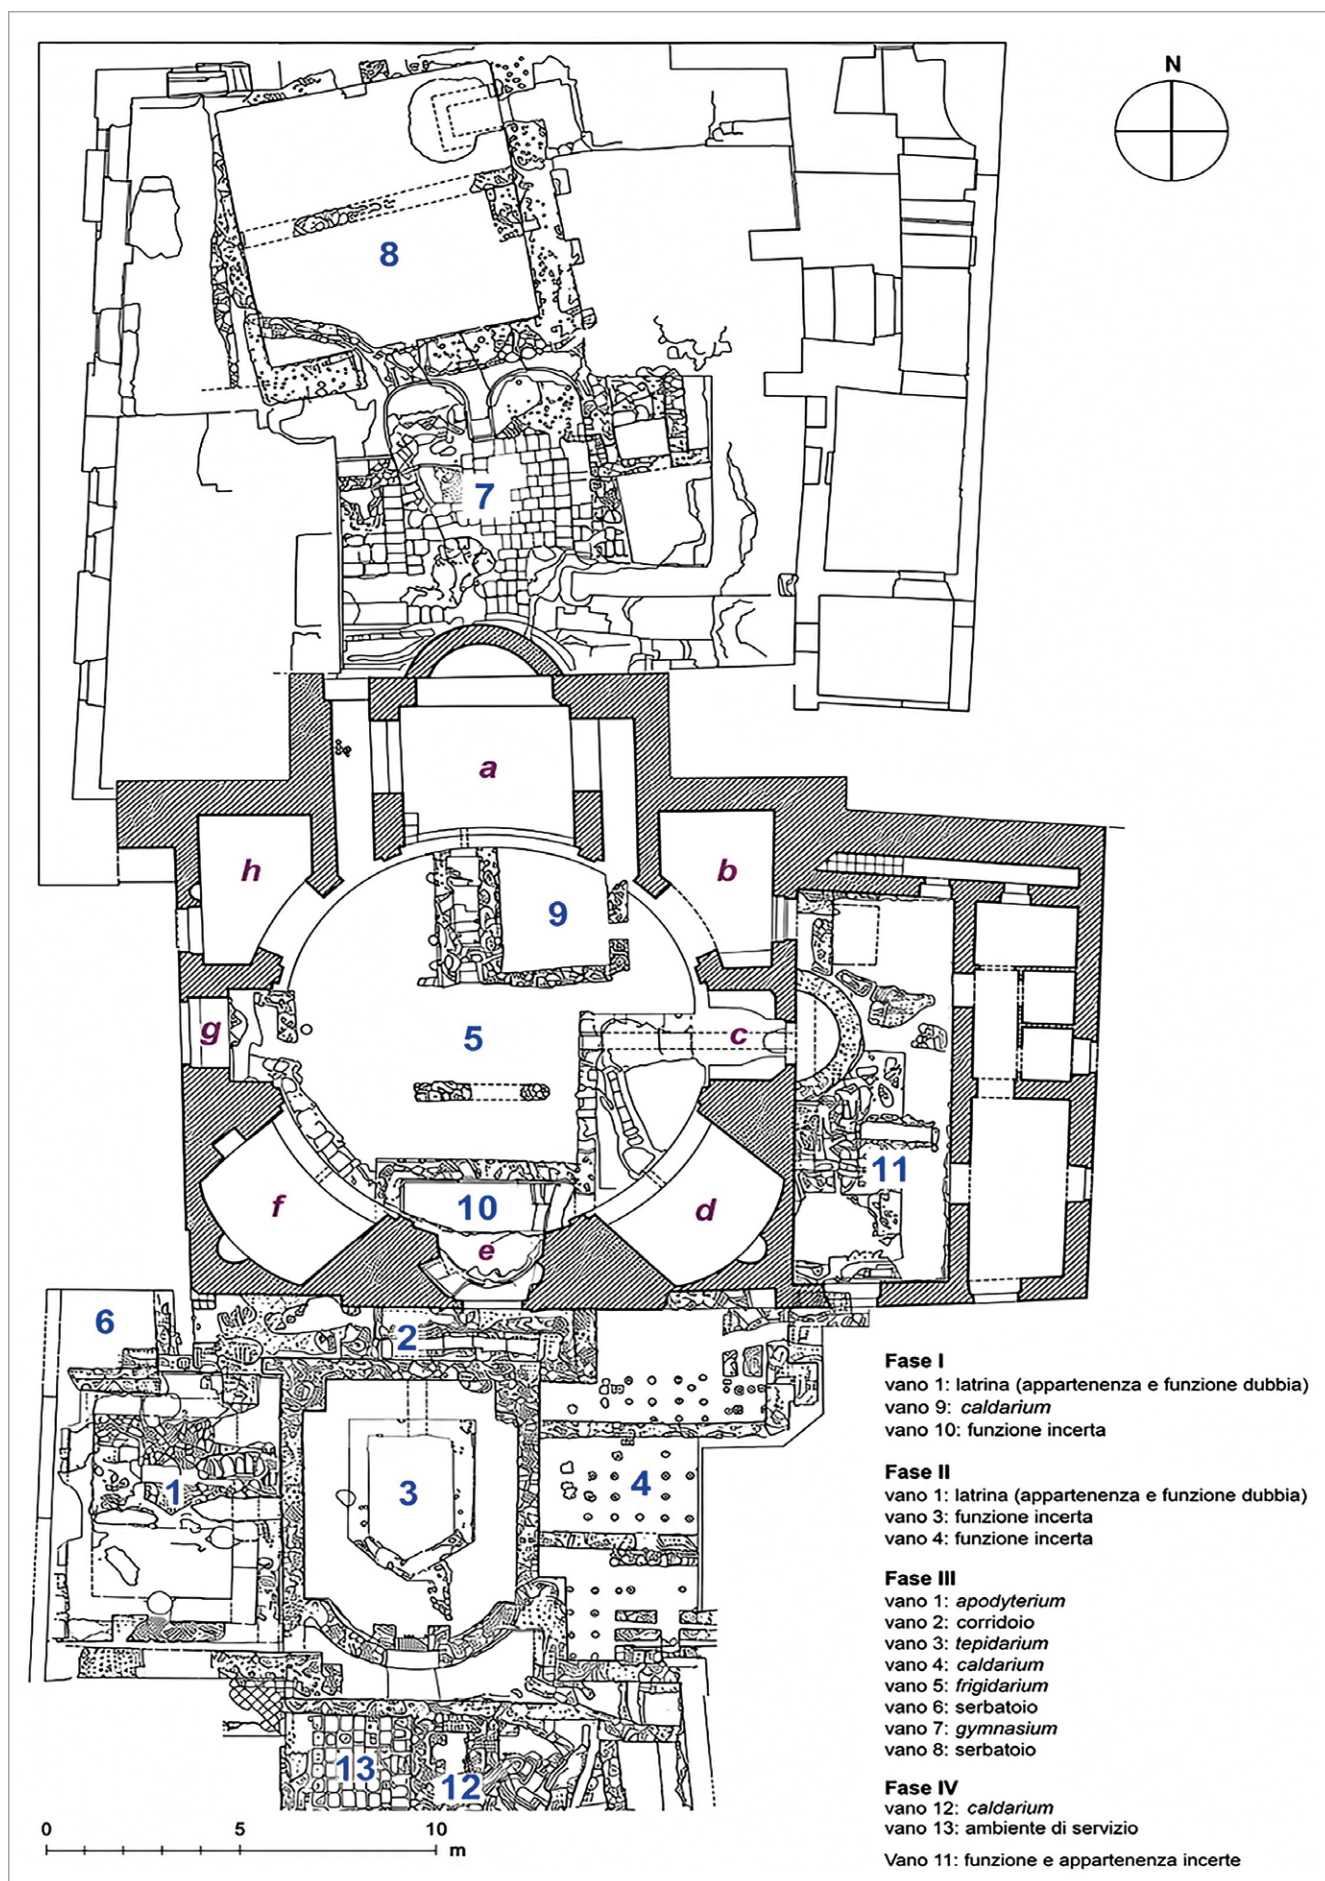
Catania, Terme della Rotonda: planimetria (da MANGANELLI 2019).
